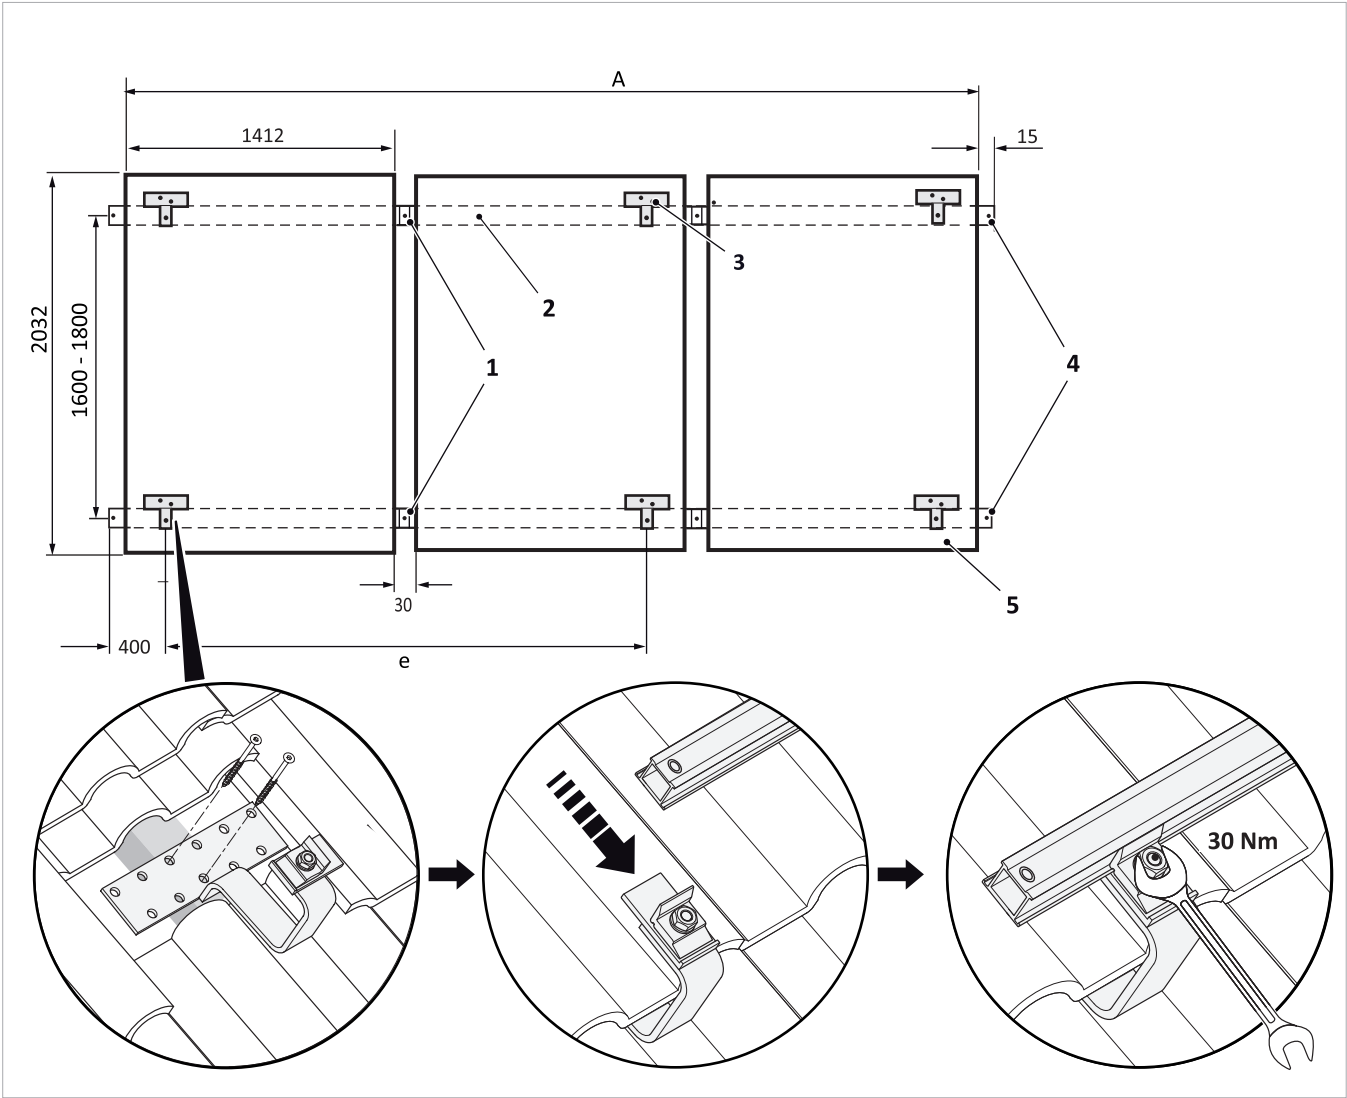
Nebeneinandermontage der Dachhalter und Montageschienen
